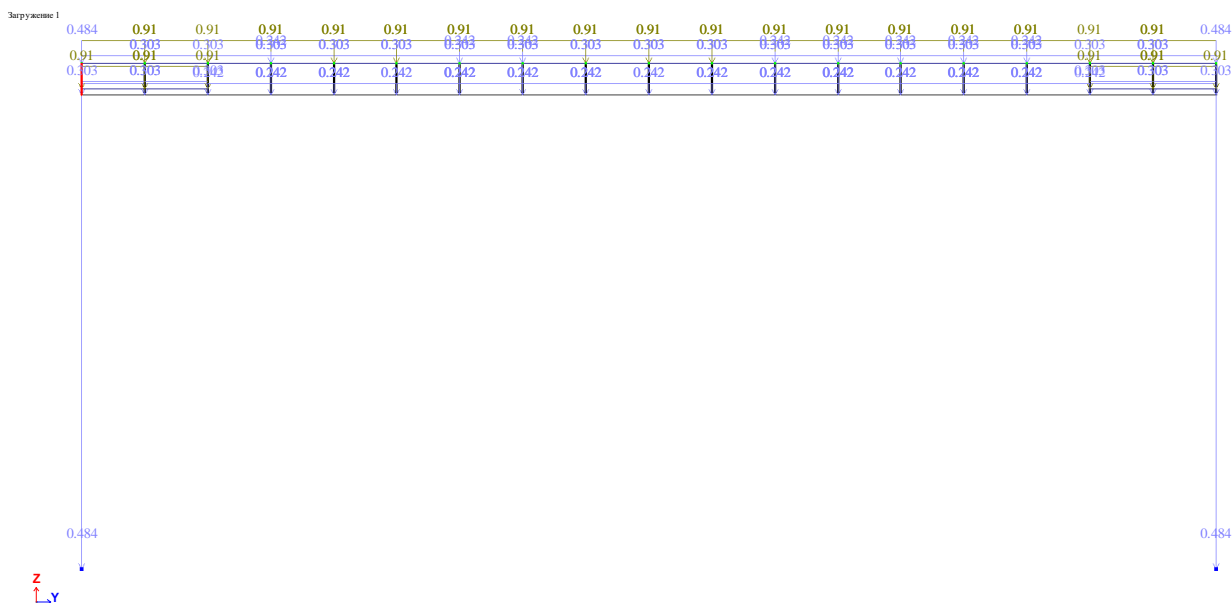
Схема нагружения на перекрытие в проекции XOZ
